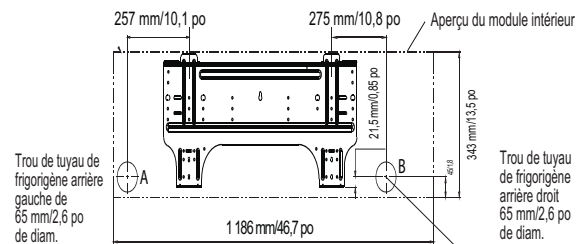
Plaques de montage 40MKCB18B et 40MKCB22B
